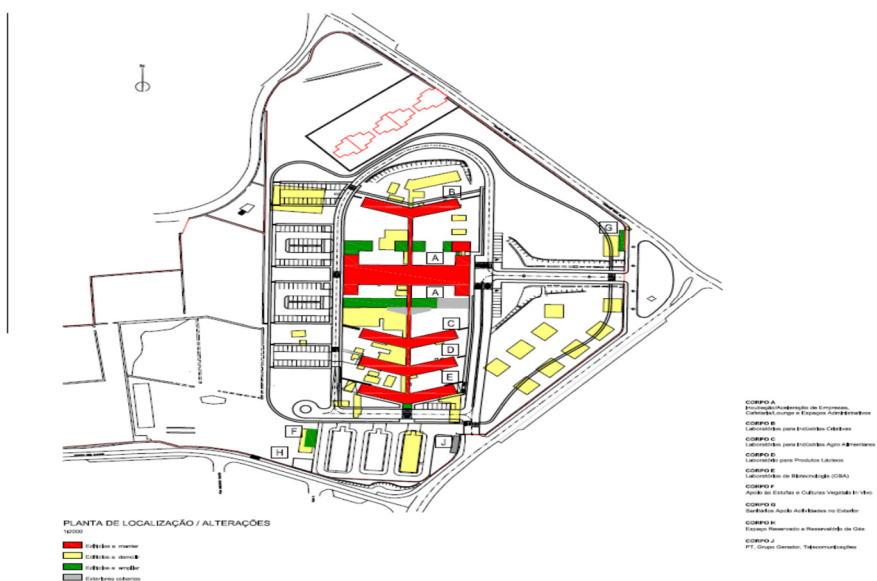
PLANTA IMPLANTAÇÃO DO TERINOV
